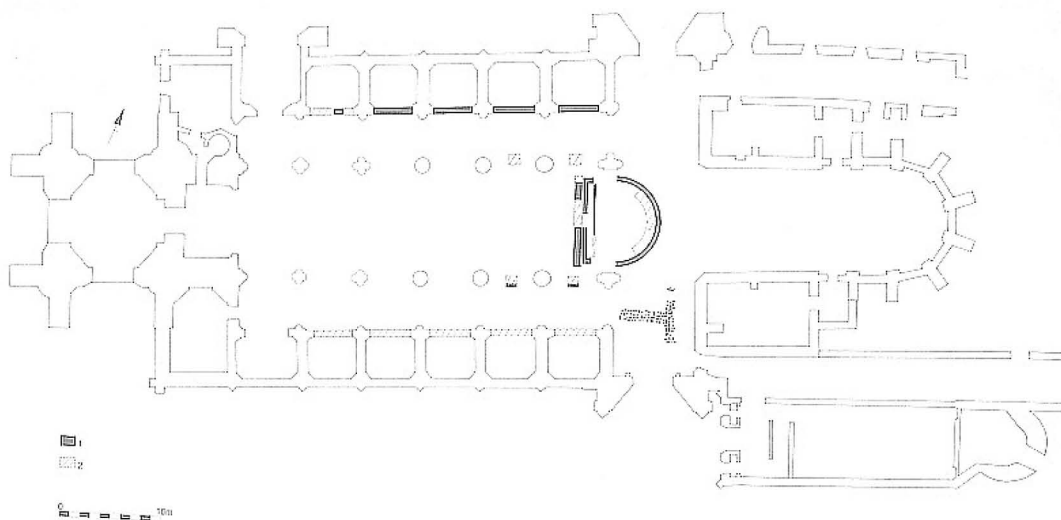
Voorlopig plan 4<sup>de</sup> eeuwse kerk
